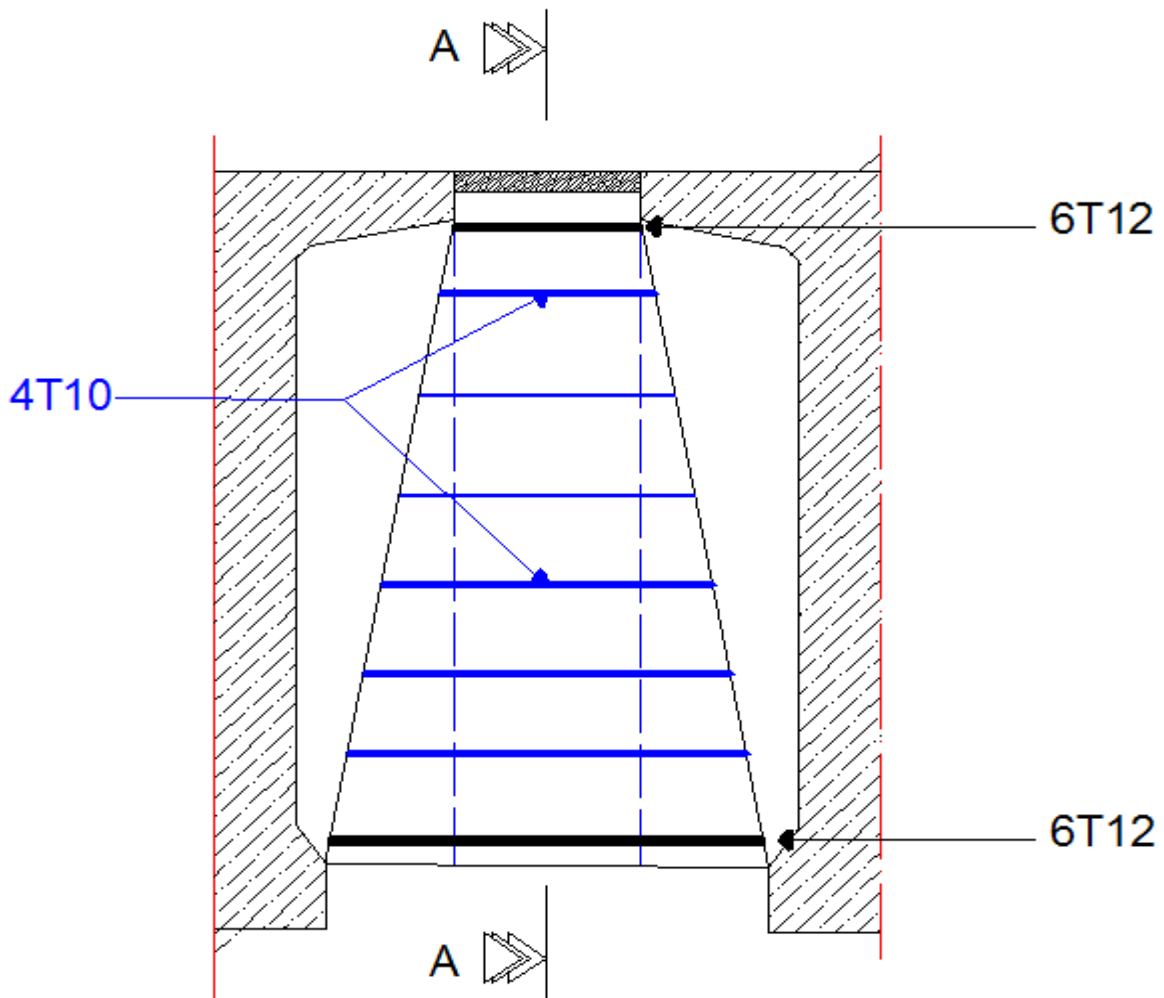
Coupe de ferrailage de l'entretoise d'about
